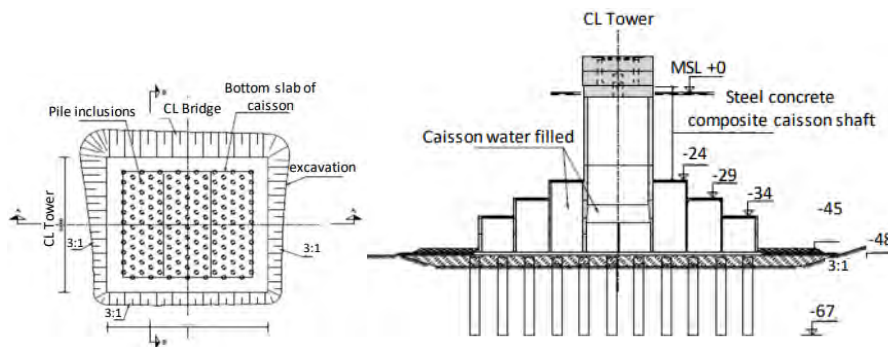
Fondazioni del «1915 Çanakkale Bridge»
